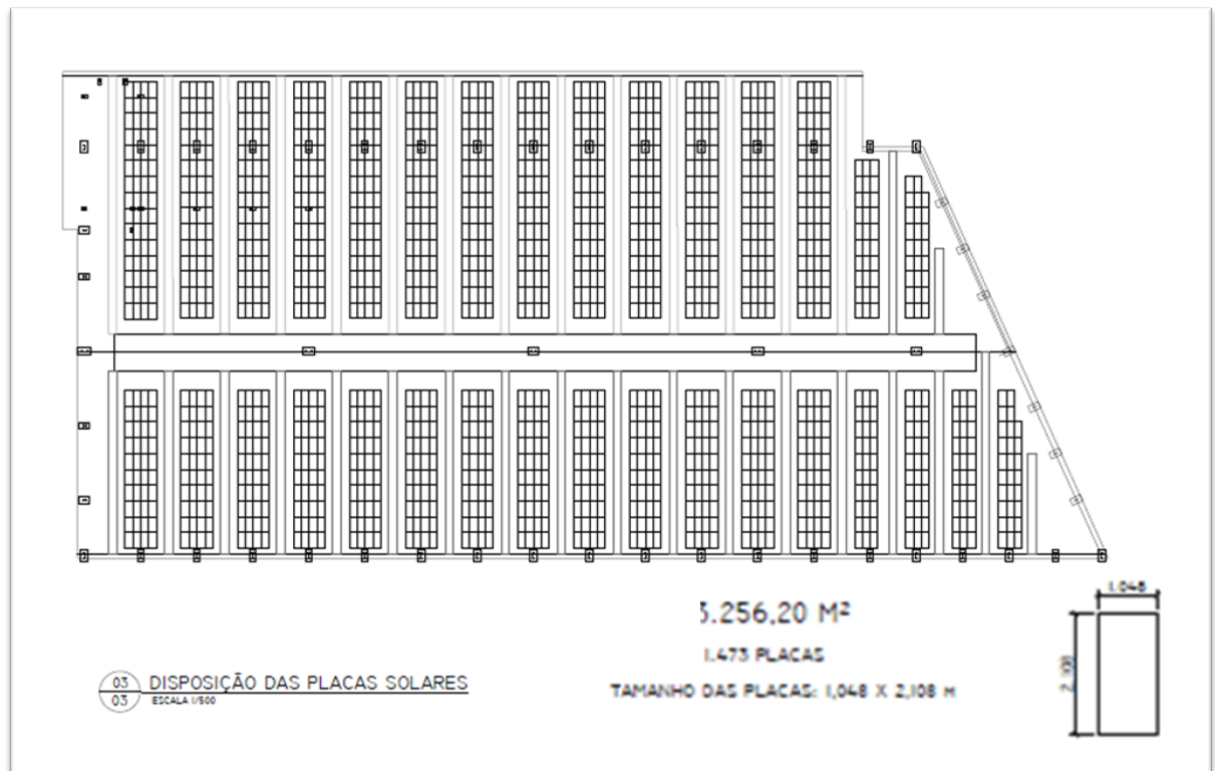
Planta do telhado com a disposição dos módulos Fotovoltaicos.
